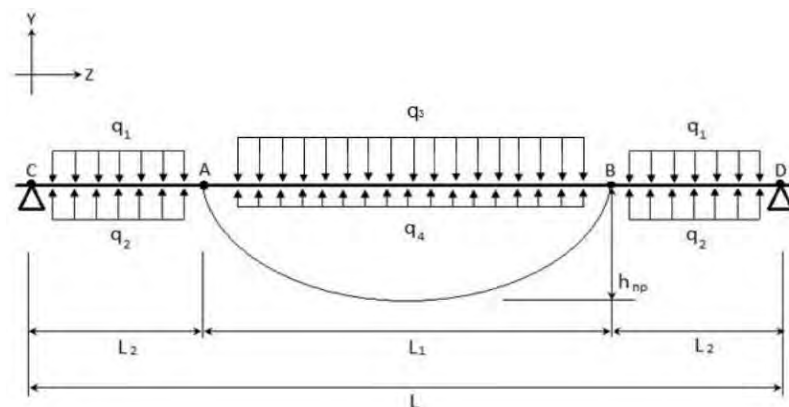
Распределение нагрузки трубопровода в зоне растепления грунта:
